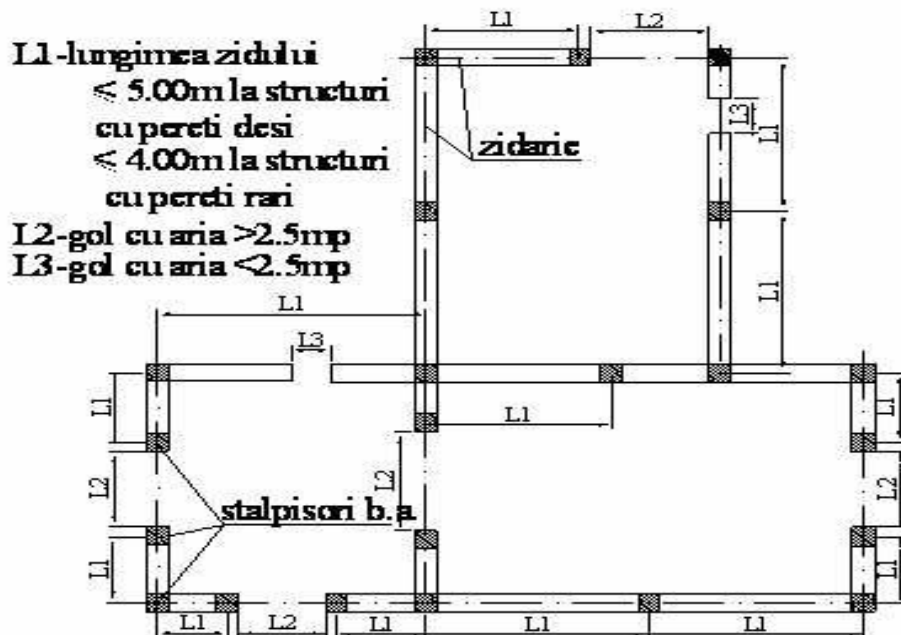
Poziționarea stâlpișorilor din beton armat la structuri din zidărie confinată
